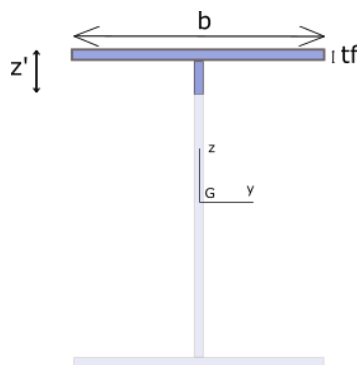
Coupe dans l'âme d'une section transversale en I
